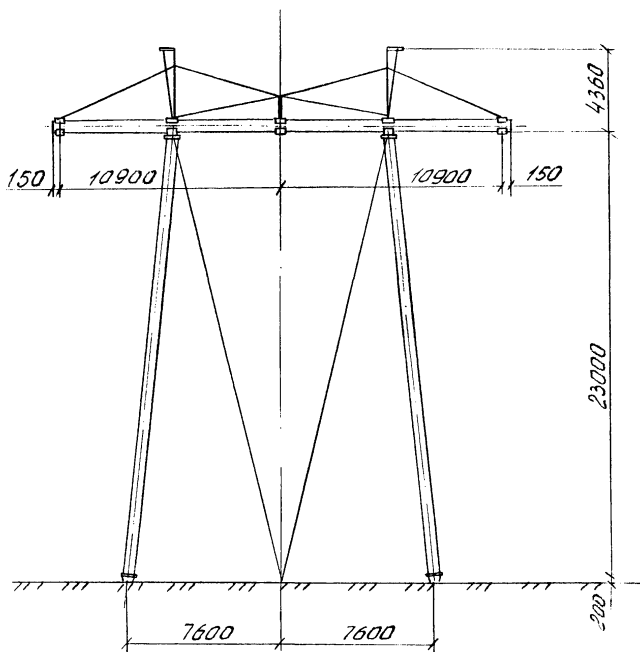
Промежуточная железобетонная опора типа ПБ 500-1
